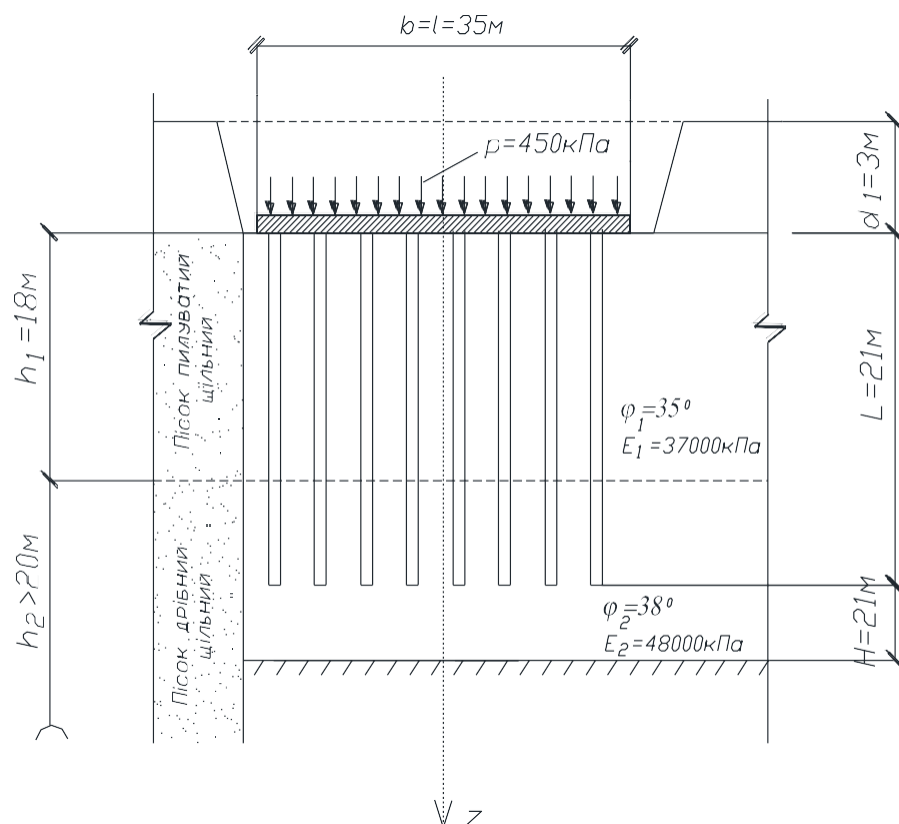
Варіант 2 закладання пальово-плитного фундаменту в ІГЕ-2
